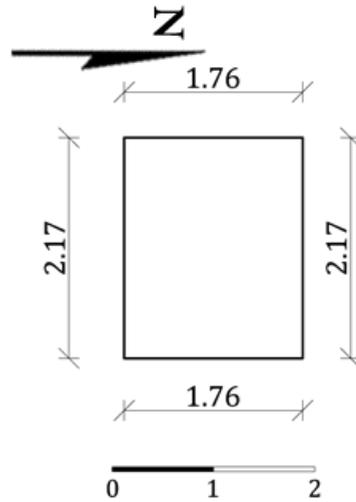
مسقط أفقي للمنور بدهليز المدخل بمدرسة ابن تغري (عمل الباحثة)
